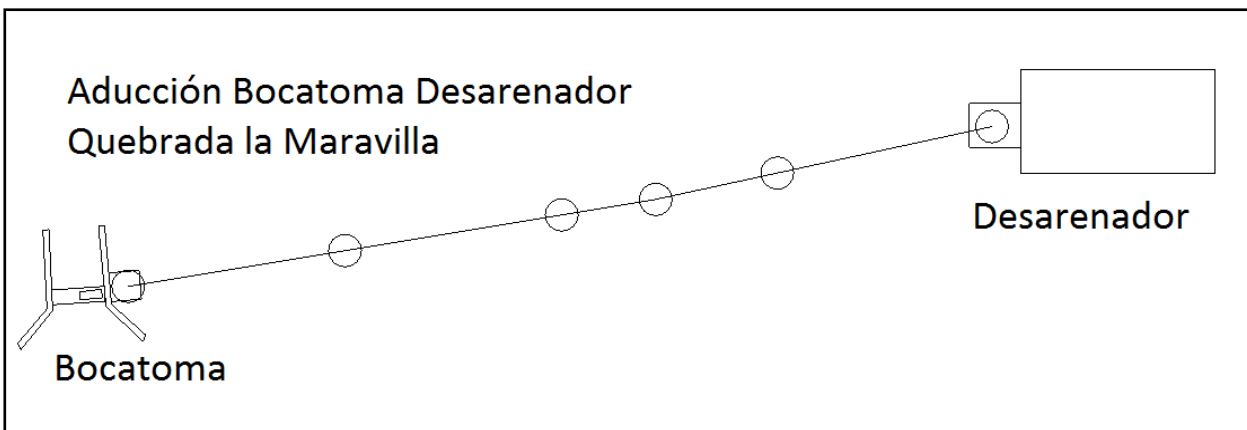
Plano en planta de la Línea de aducción Bocatoma-Desarenador. Fuente: Autores del proyecto.
